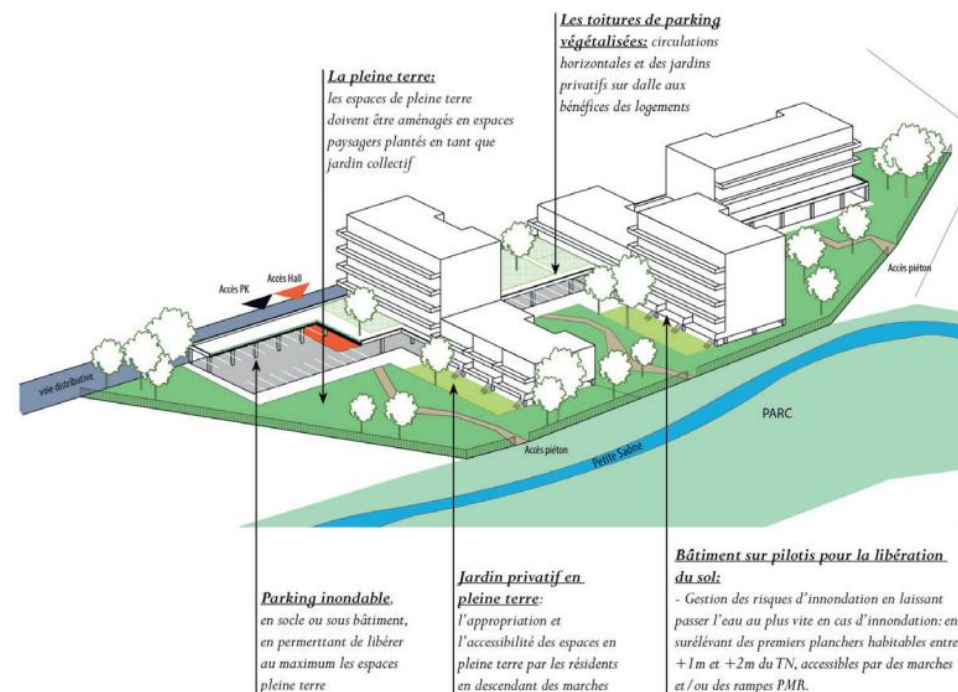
EXEMPLES DE PRINCIPES D'AMENAGEMENT A VALORISER POUR LES CONSTRUCTIONS EN ZONE INONDABLE (SOURCE : MARNIQUET - AUBOUIN / ROBERTA ILLUSTRE)
